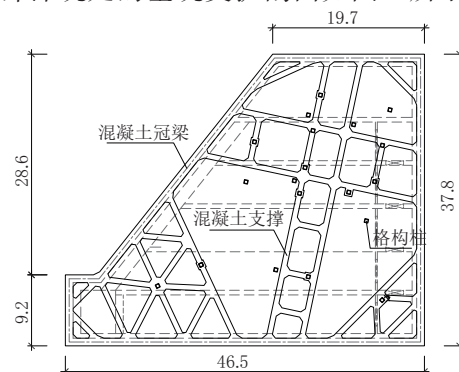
首道钢筋混凝土支撑平面布置图(单位:m)
